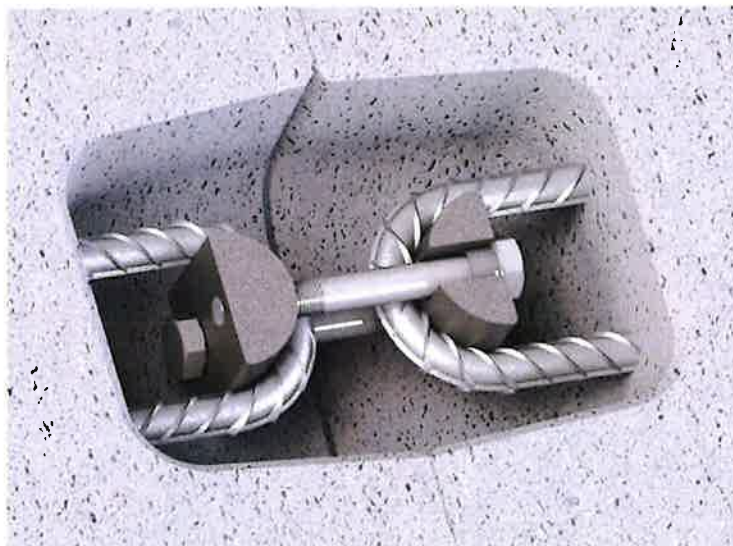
BGW-Bügelverschluss (Bügel aus Betonstahl, Schlosskörper und Schraube)
